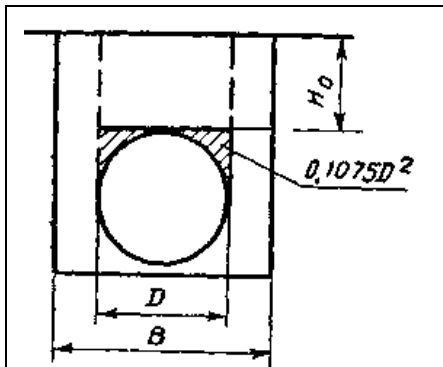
Схема к расчету вертикального давления грунта на трубопровод
